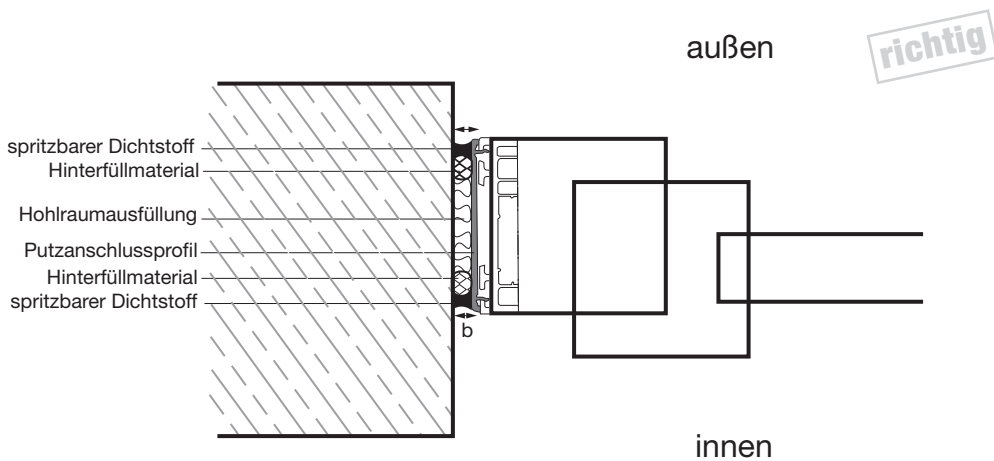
Einsatz eines Abdeckprofils ermöglicht eine fachgerechte Fugendimensionierung innen und außen.
